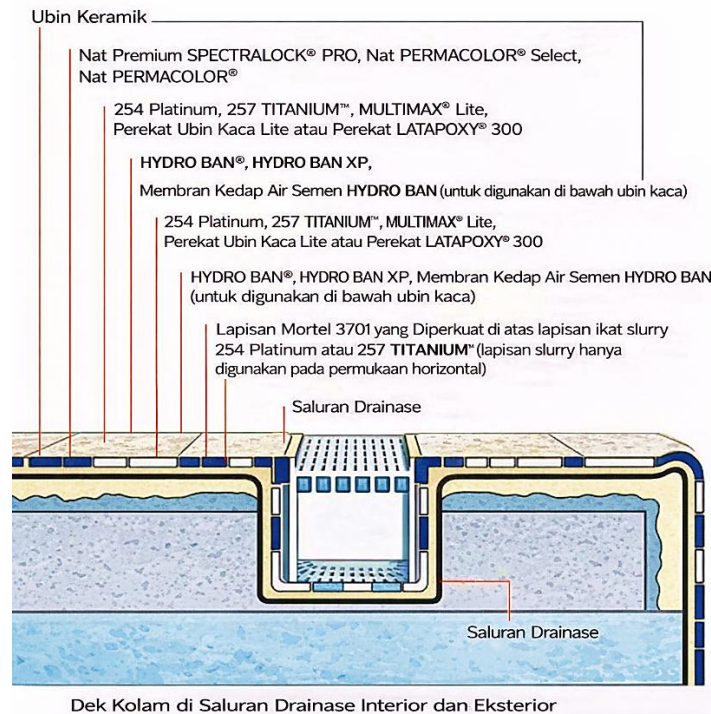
Sistem Lantai Tebal / Kedap Air dengan detail drainase.
